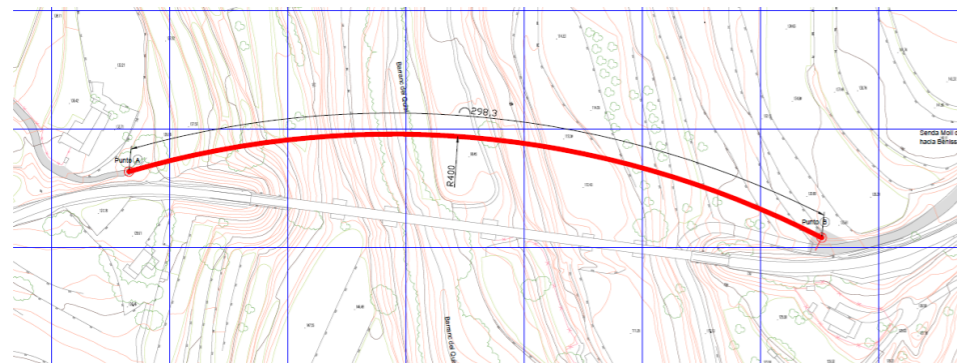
Vista en planta de la geometría curvada de la pasarela en su emplazamiento. Fuente: Elaboración Propia (AutoCAD)
